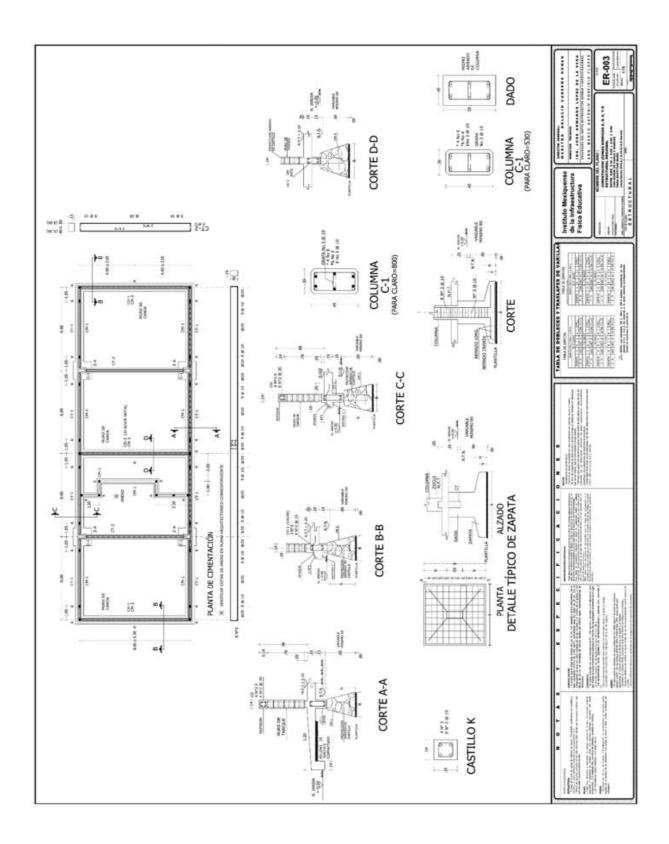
Detalle Plano de cimentación primaria Vicente Guerrero.
